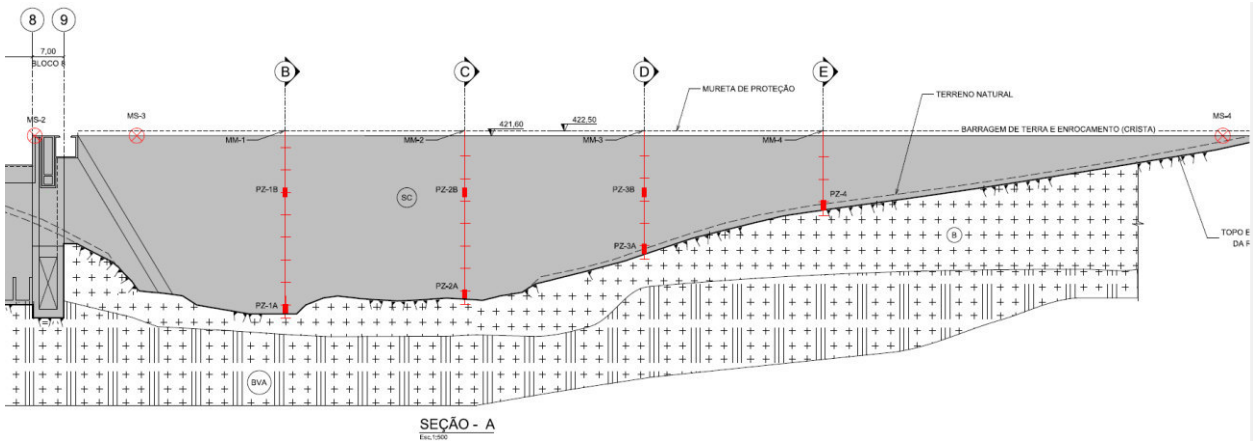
Seção longitudinal de monitoramento da barragem de enrocamento.
